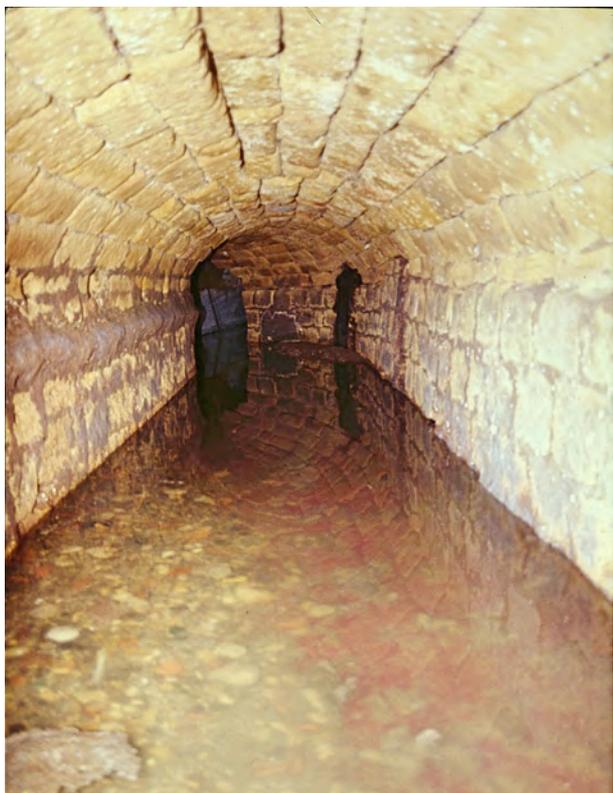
Foto C Il Canale del Papireto sotto piazza Beati Paoli
